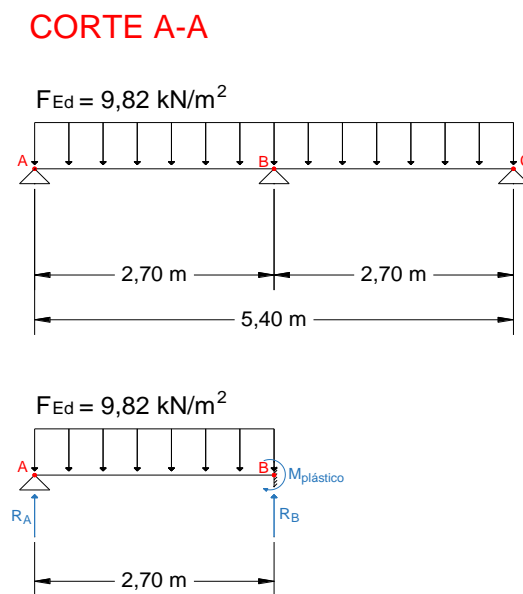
Representação, em corte, da carga atuante no pavimento
